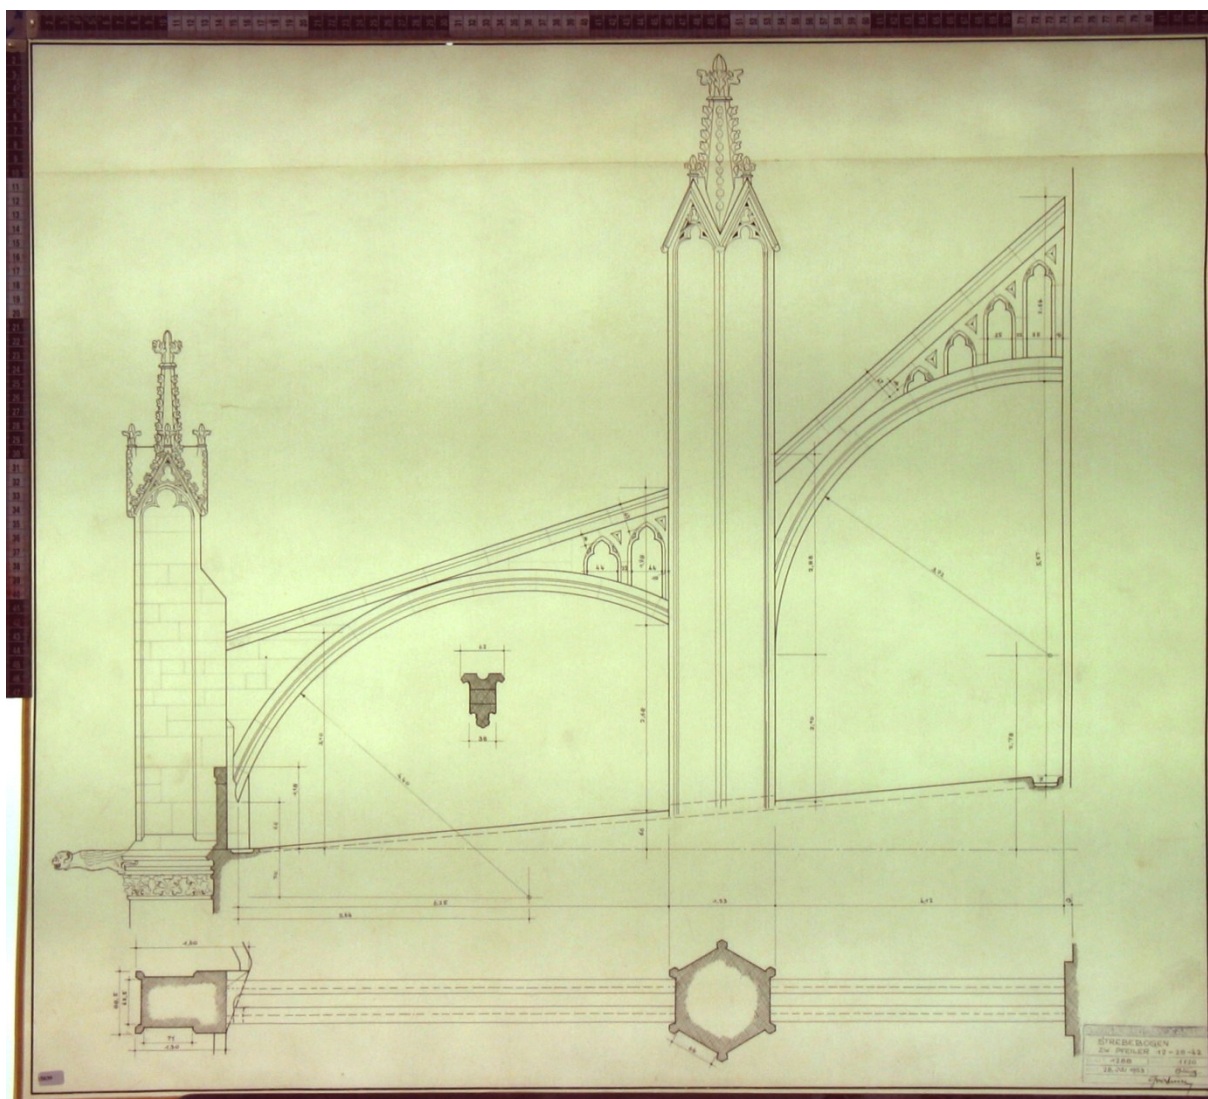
Připravený model vysokého chóru s opěrným systémem 14-30-44
